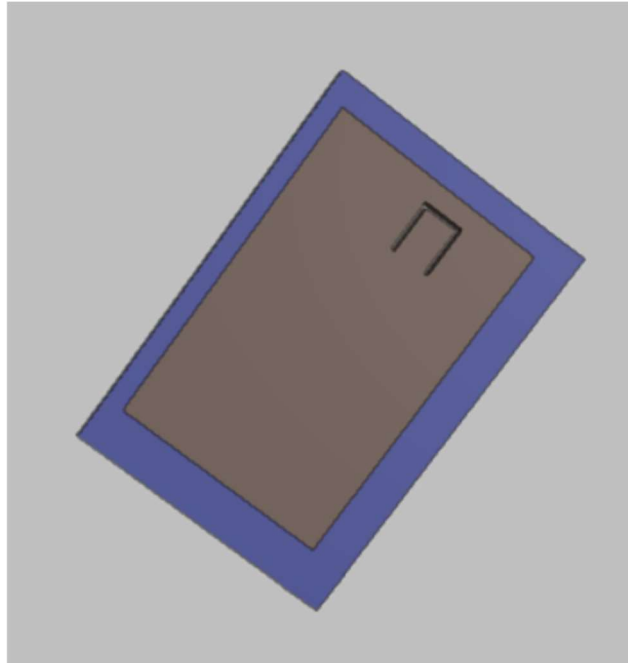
Losa de cimentación unida al muro de sótano (visor 3D de CYPECAD)
